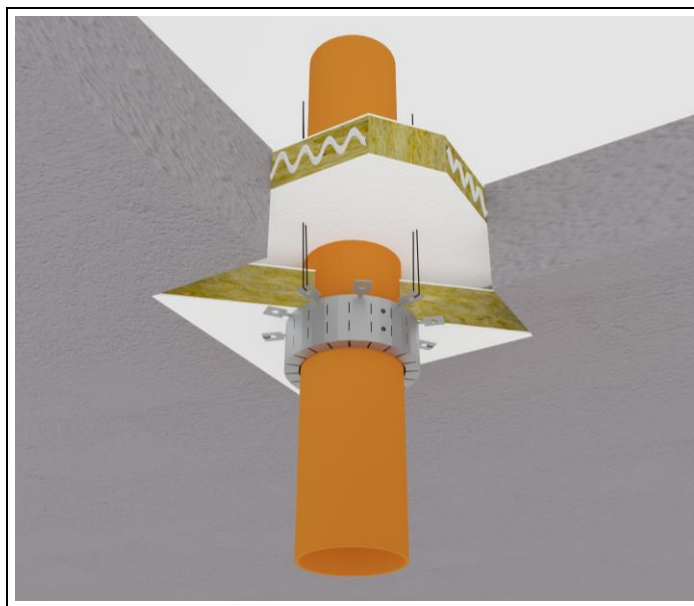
Esempio di un KF-Multicollar fissato con cavi d'acciaio ad un solaio.
